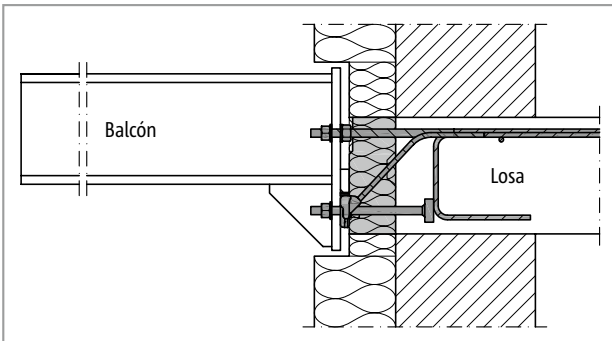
Schöck Isokorb® T tipo SK: Paso sin barreras por desplazamiento de altura
